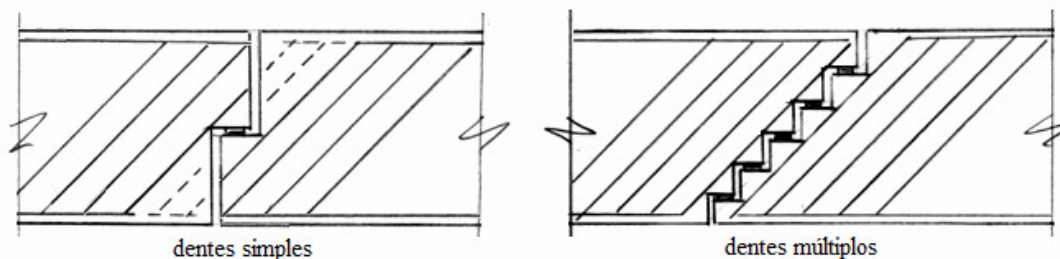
Detalhes das armaduras internas de dentes Gerber simples e múltiplos de concreto armado.
